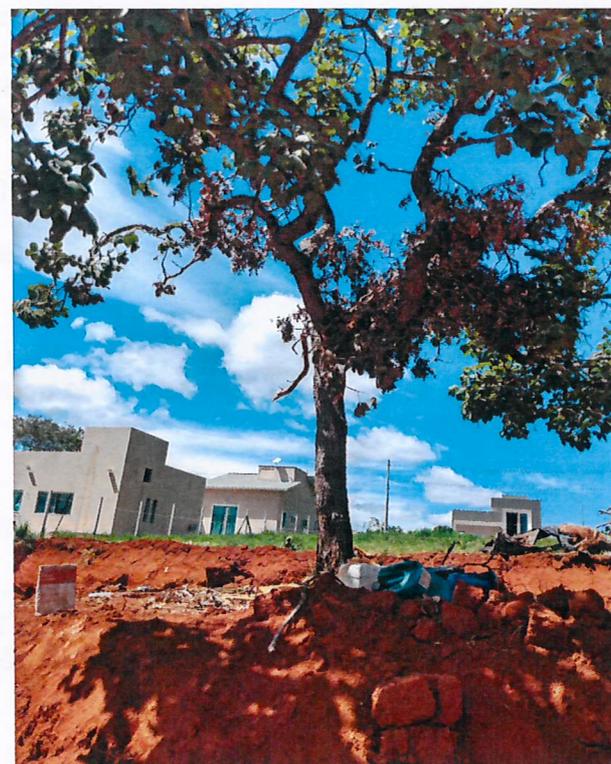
Pequizeiro situado no talude após o corte do terreno.
